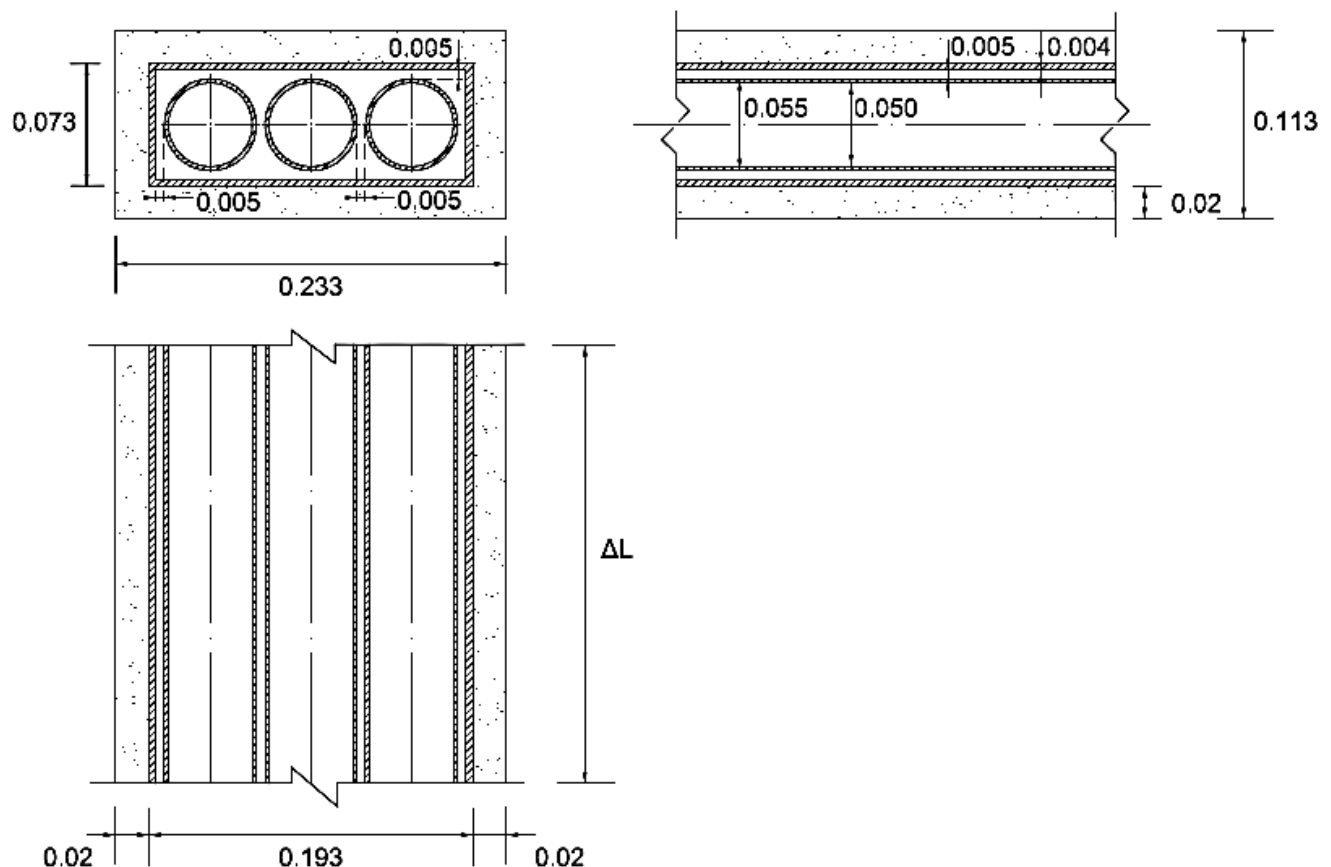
Alzado, Perfil y Planta del diseño del intercambiador de calor.
